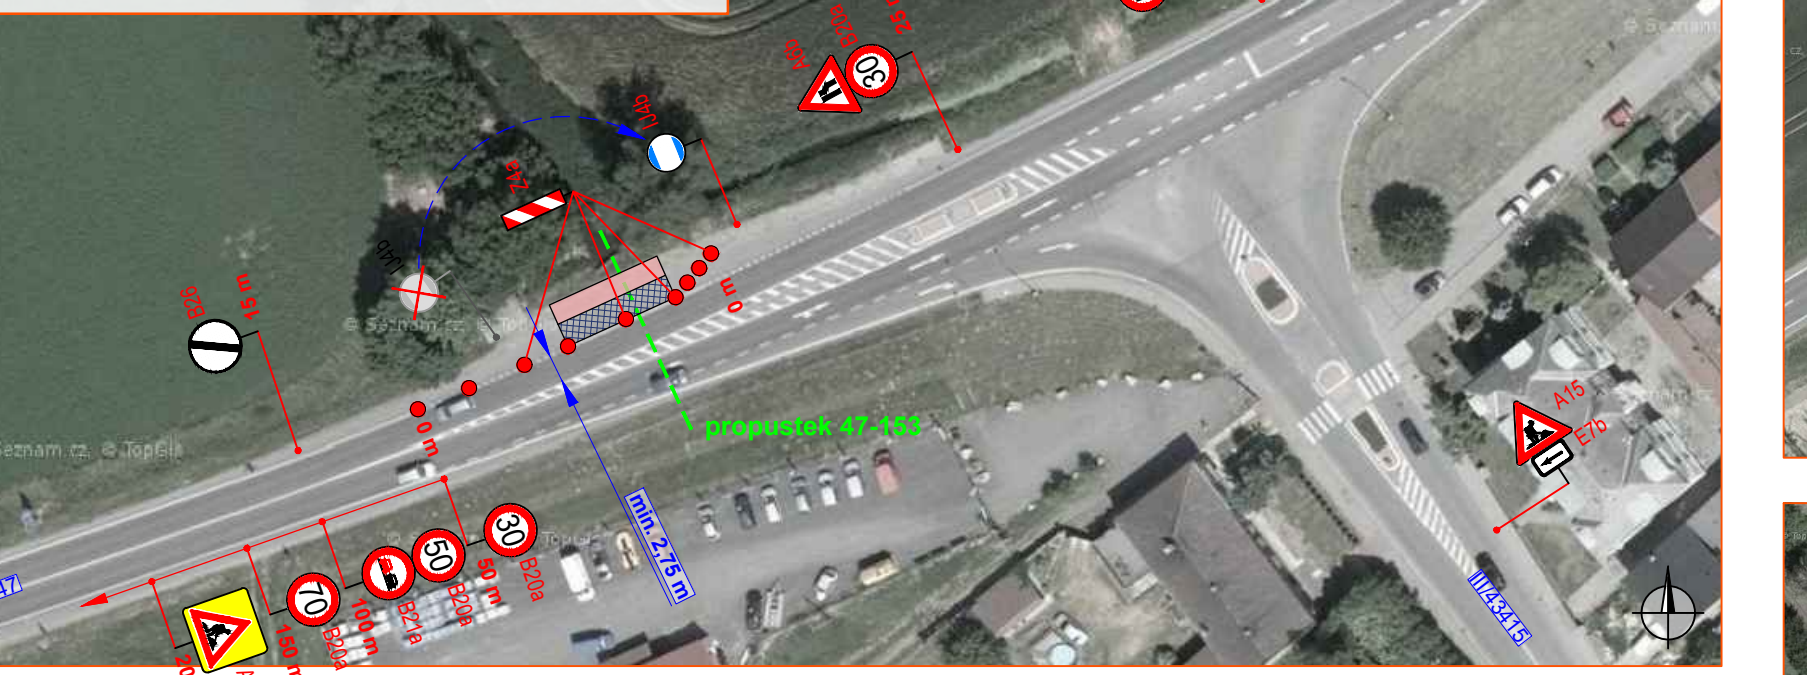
PRAVÝ JÍZDNÍ PÁS
